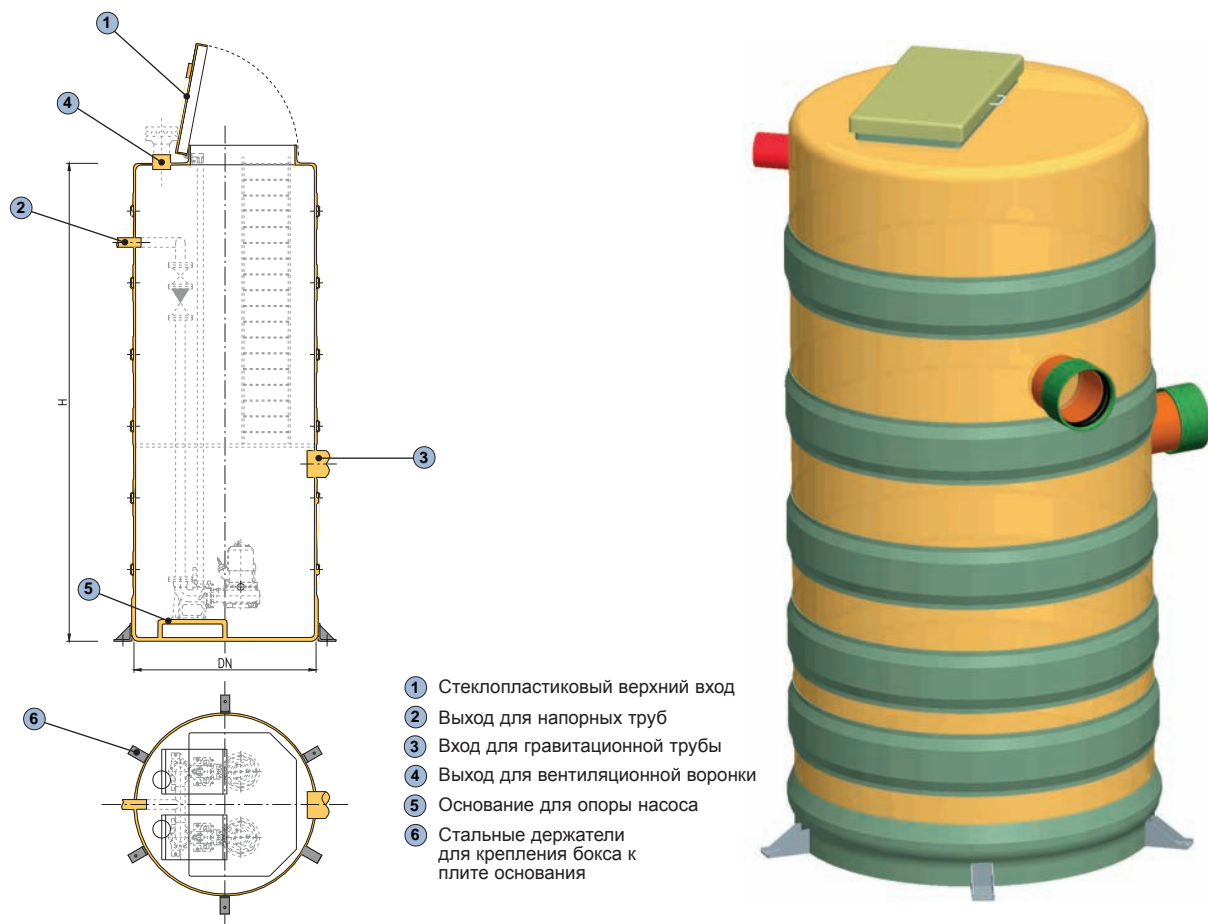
Возможное решение для размещения насосной станции в стеклопластиковом смотровом колодце в зонах без нагрузки транспорта, основанное на тонкостенной стеклопластиковой трубе, укрепленной ребрами
